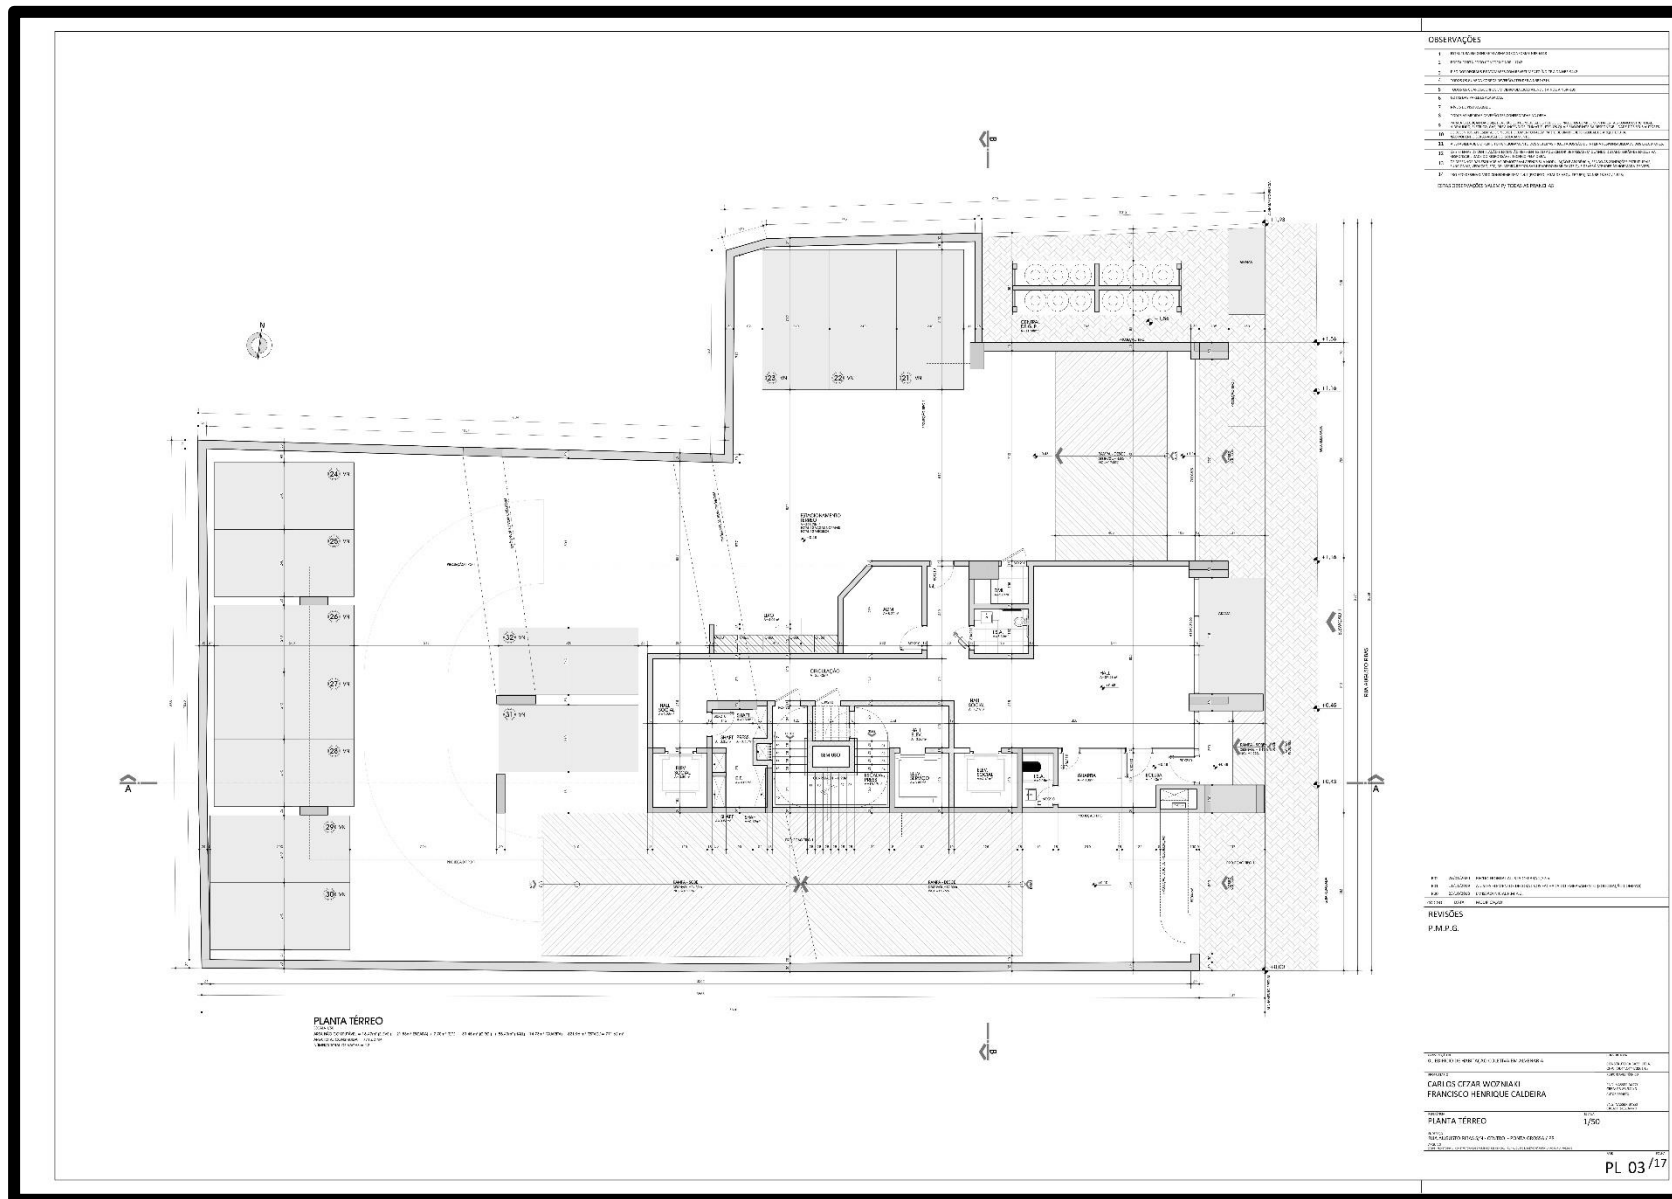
Planta pavimento térreo. Fonte: Construtora Bazzi (2020).
